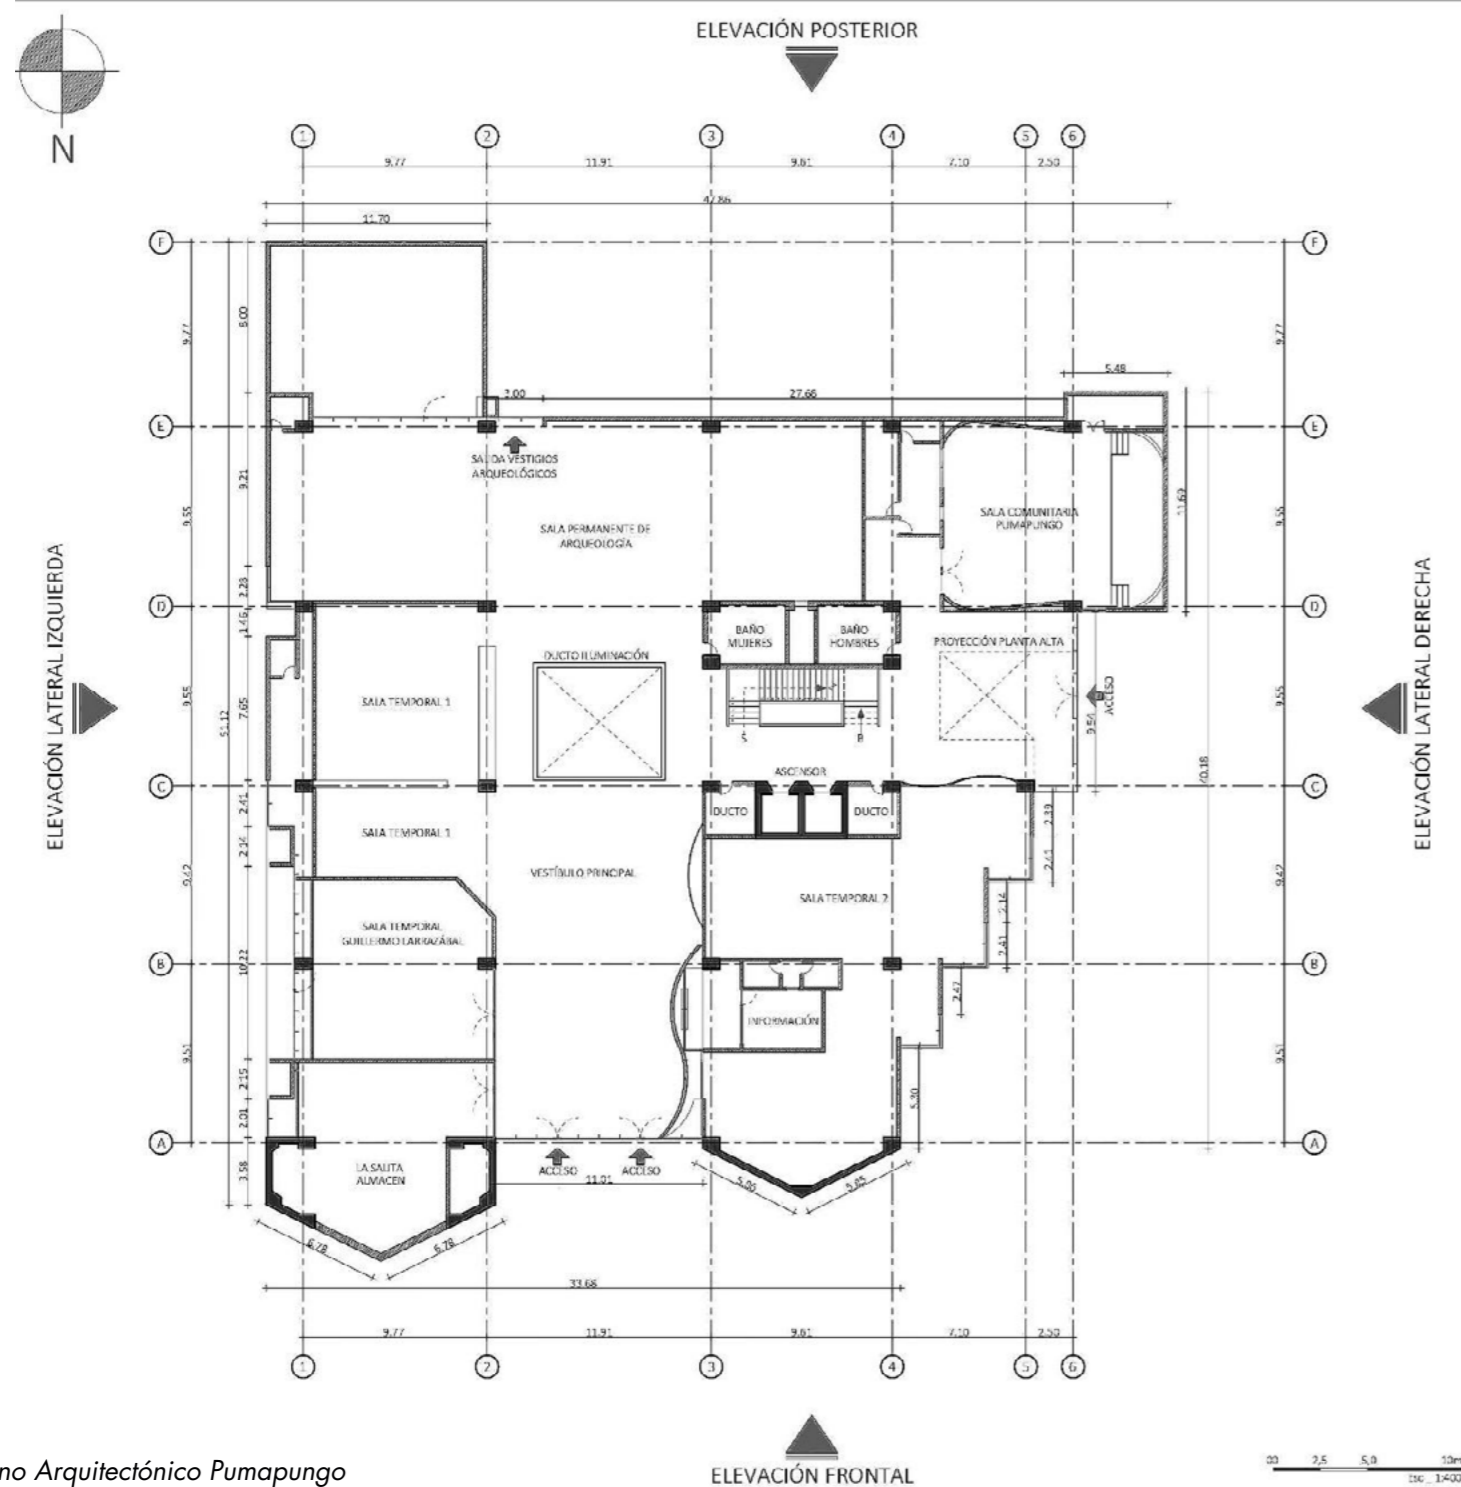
Zonificación Primera Planta Museo Pumapungo
